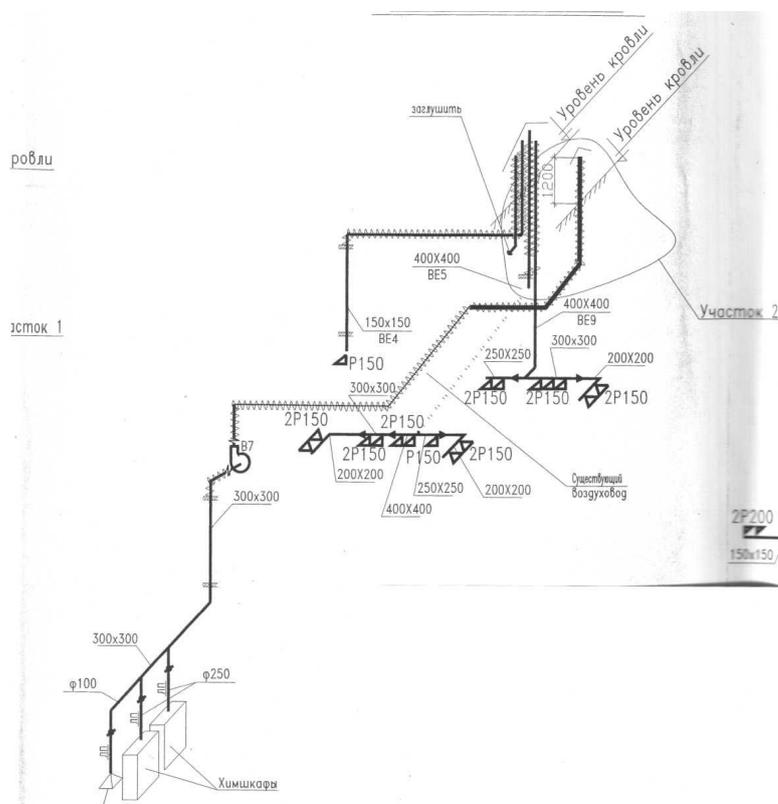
Схема расположения вентилятора В7 и воздуховодов ВЕ4, ВЕ5, ВЕ9.
